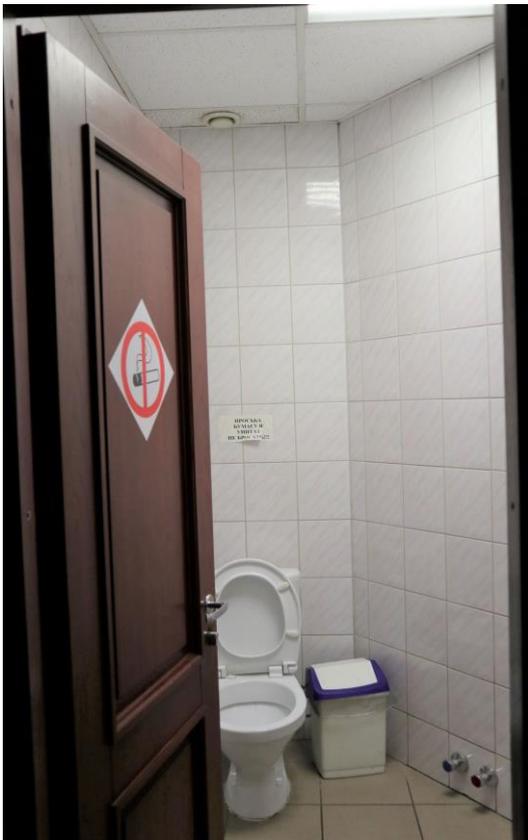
3 этаж, санузел, помещение 28Н (13).
